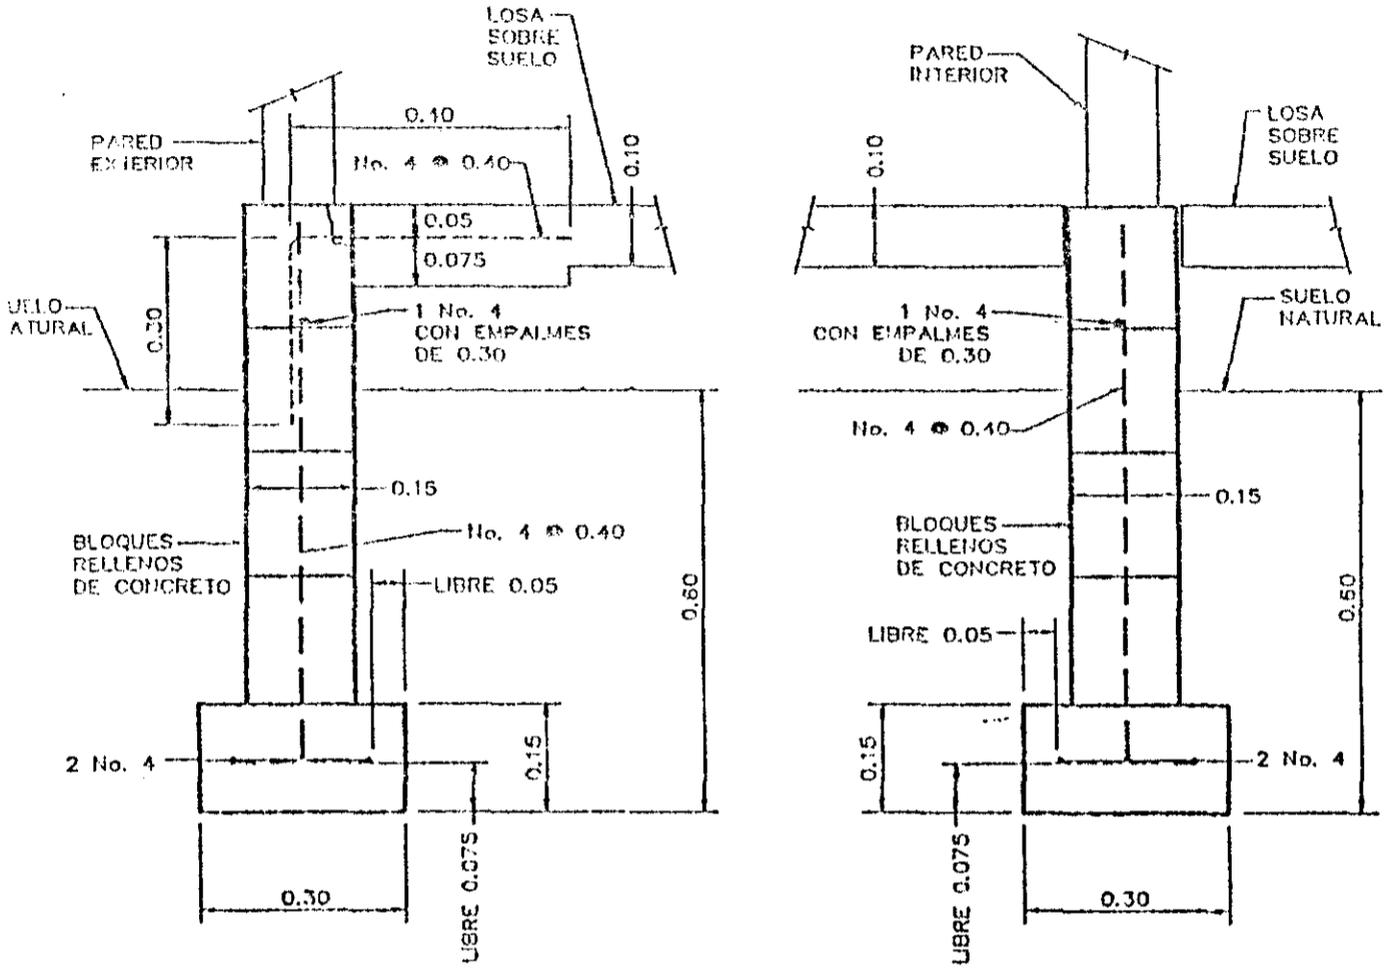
SECCIONES TRANSVERSALES DE CIMIENTOS DE PAREDES
